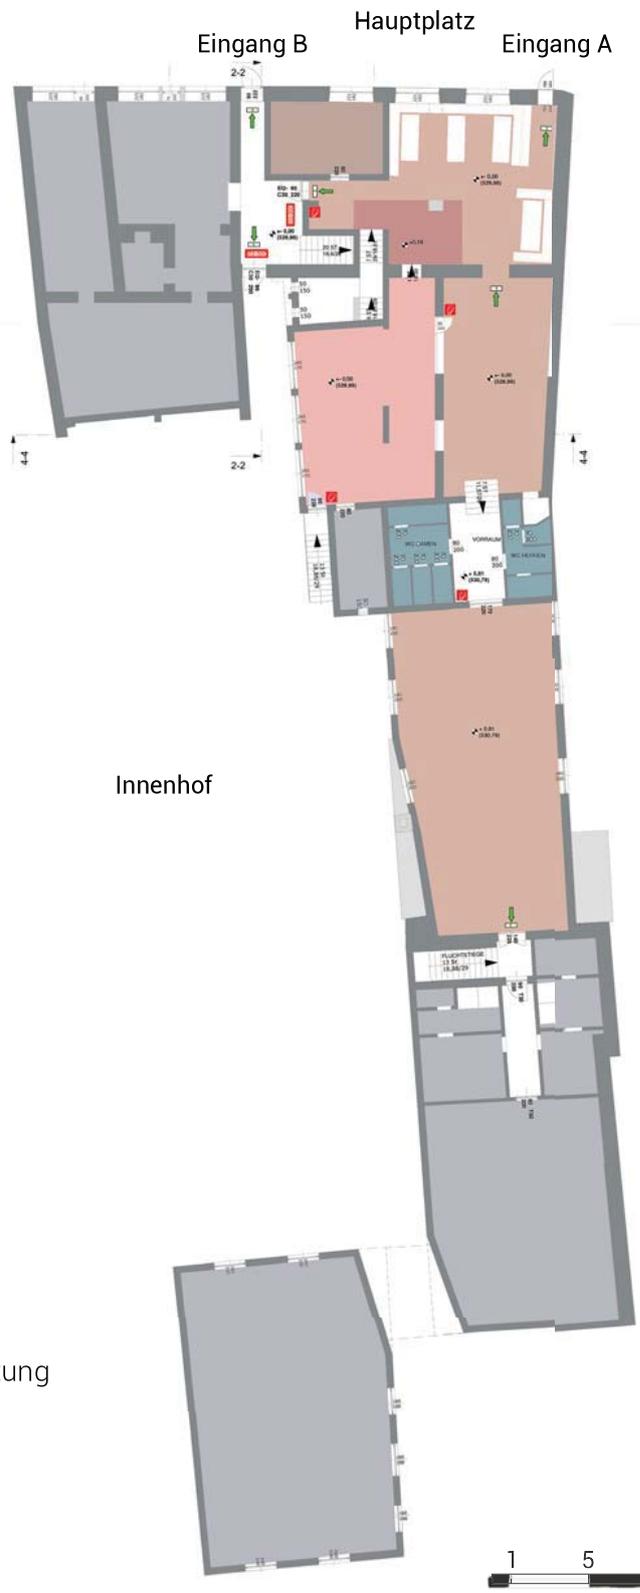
Grundriss Erdgeschoss Hotel zur Sonne
